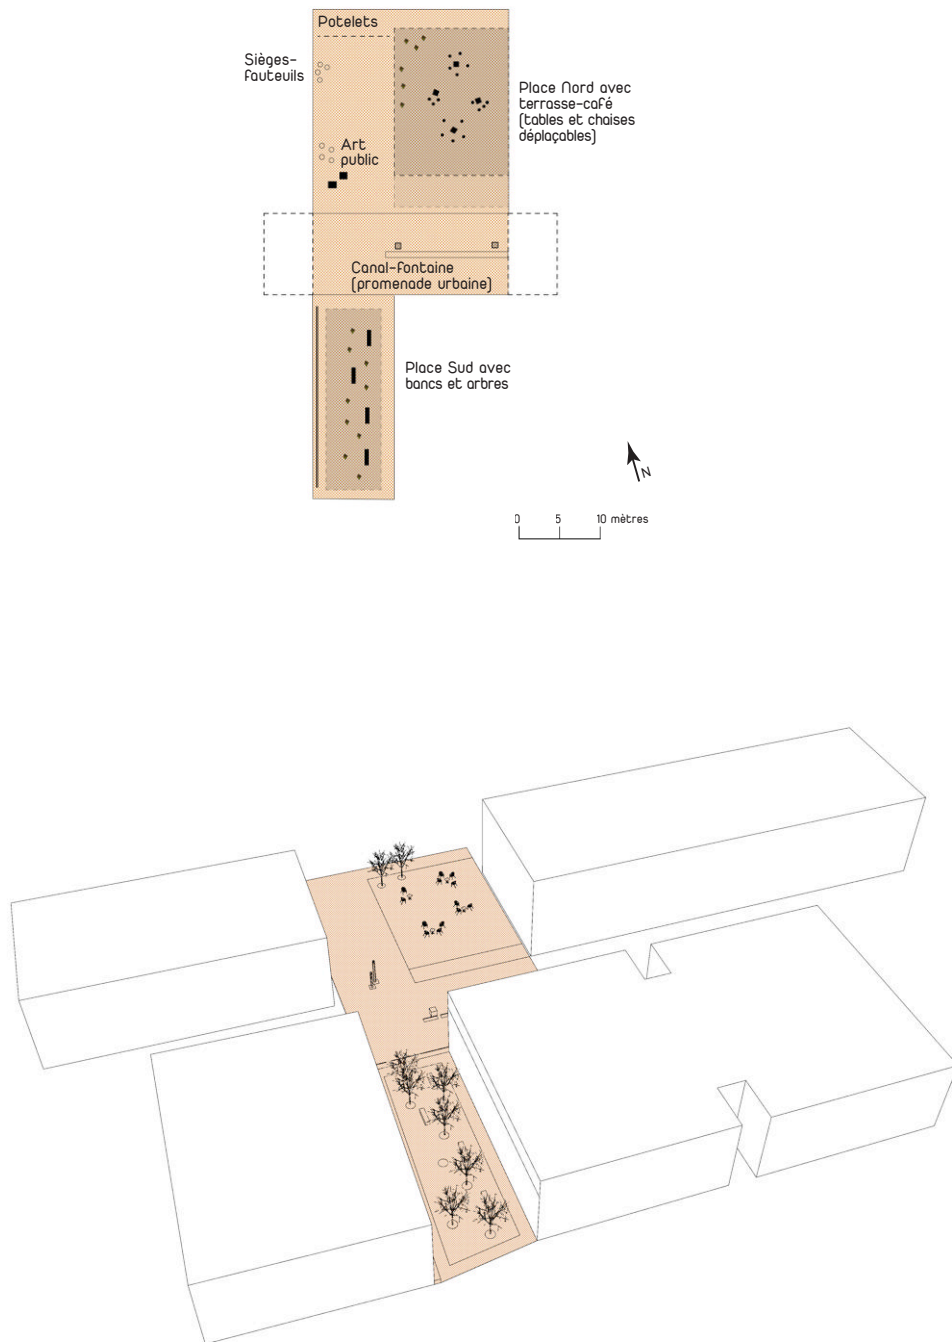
Plan de site et vue 3D des Places Merciers (Source : Ian Losa)
